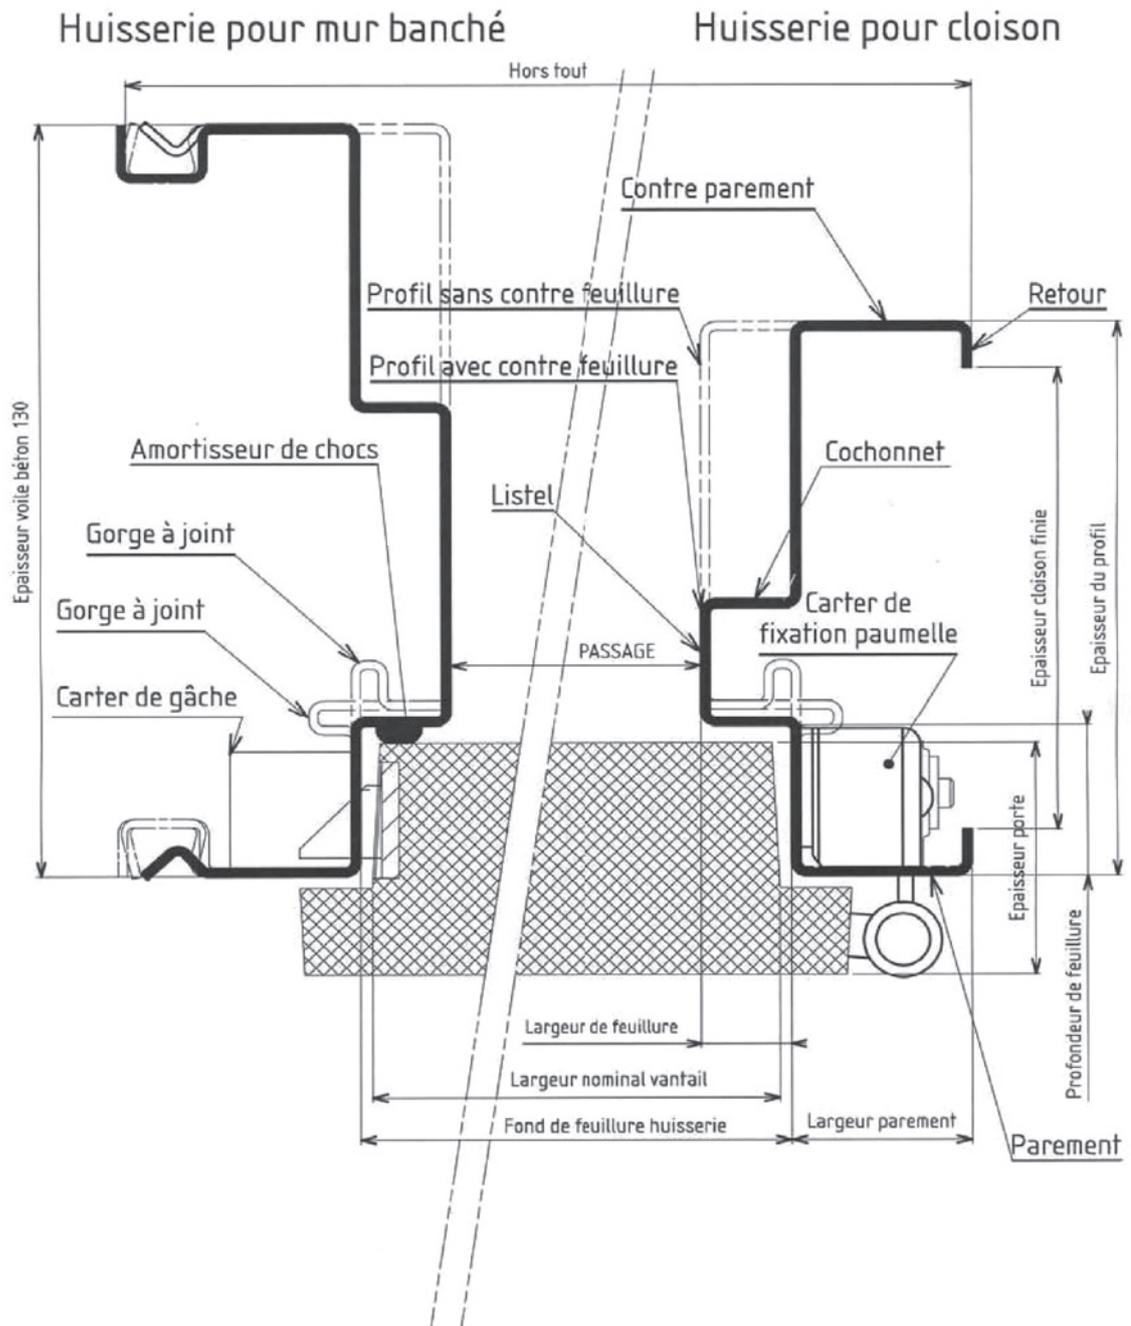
Coupe horizontale d' huisserie pour porte à recouvrement
